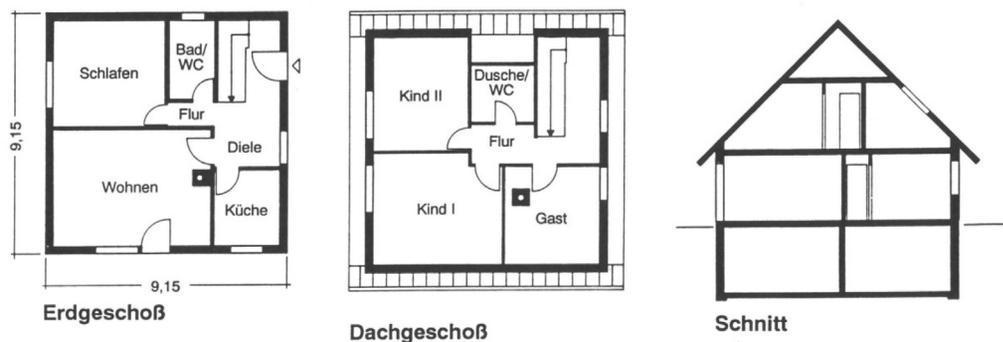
Darstellung der Grundrisse aller Wohngeschosse sowie eines Schnittes des Beispielgebäudes ‚Einfamilienhaus‘ [42]
